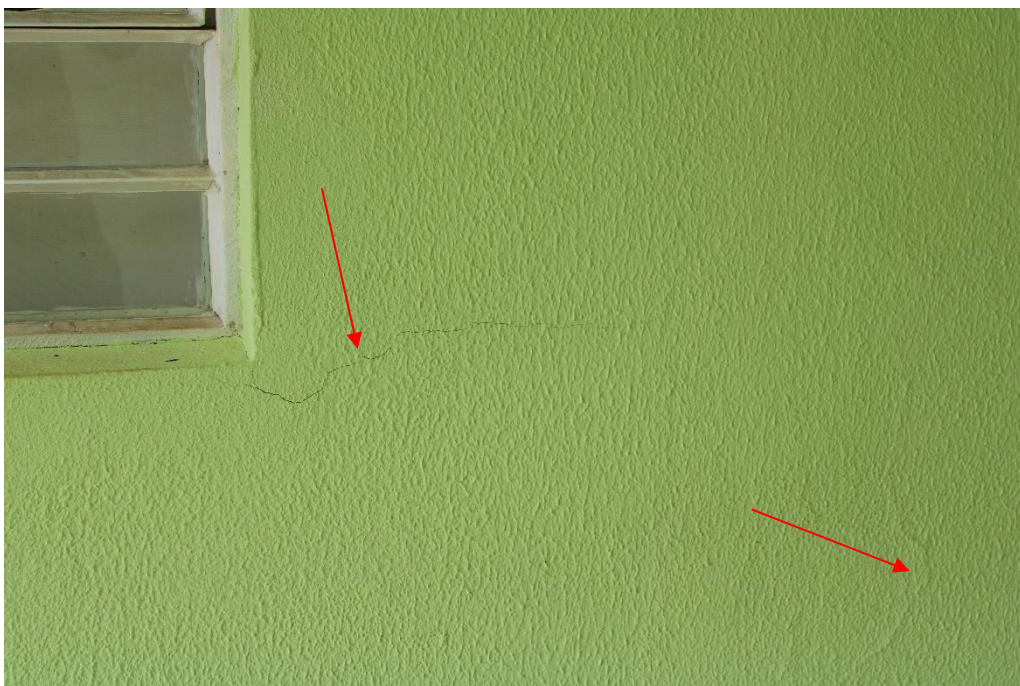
Em detalhe a Foto 133, destacando fissura horizontal em vértice inferior de janela, bem como sinais de corrosão de fissura em alvenaria.
